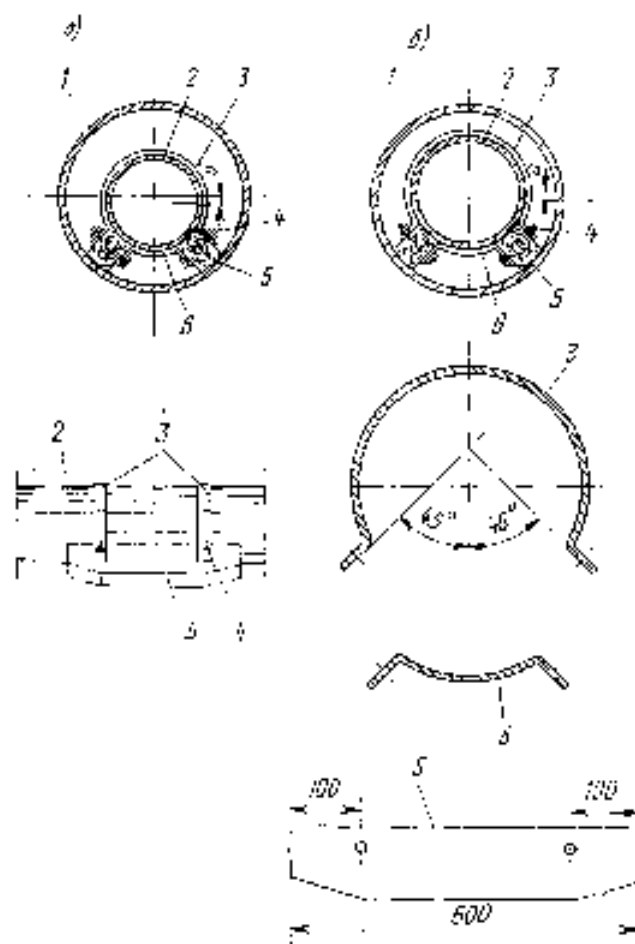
Опора с деревянными ползунками прямоугольного сечения
